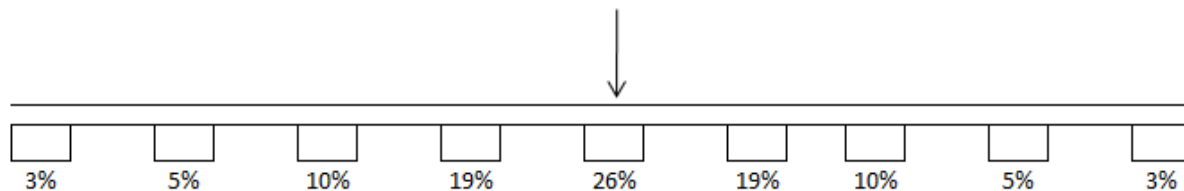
Distribuição da carga pelas travessas adjacentes ao ponto de aplicação. Carga sobre uma travessa
